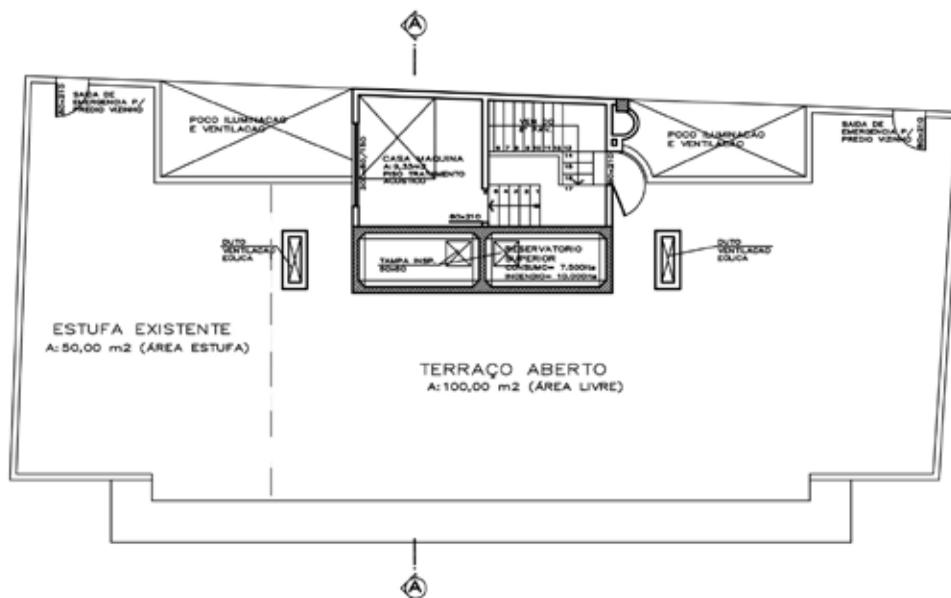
Planta da cobertura existente. Fonte: desenho elaborado pelo autor.
